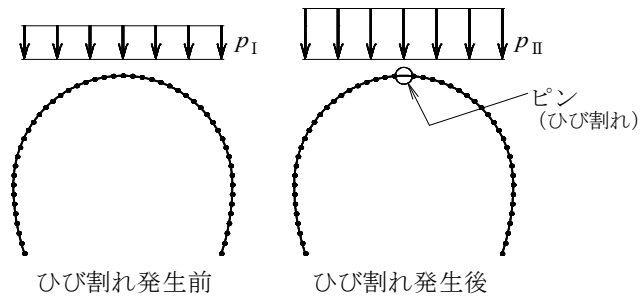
ひび割れのモデル化（概念図）
